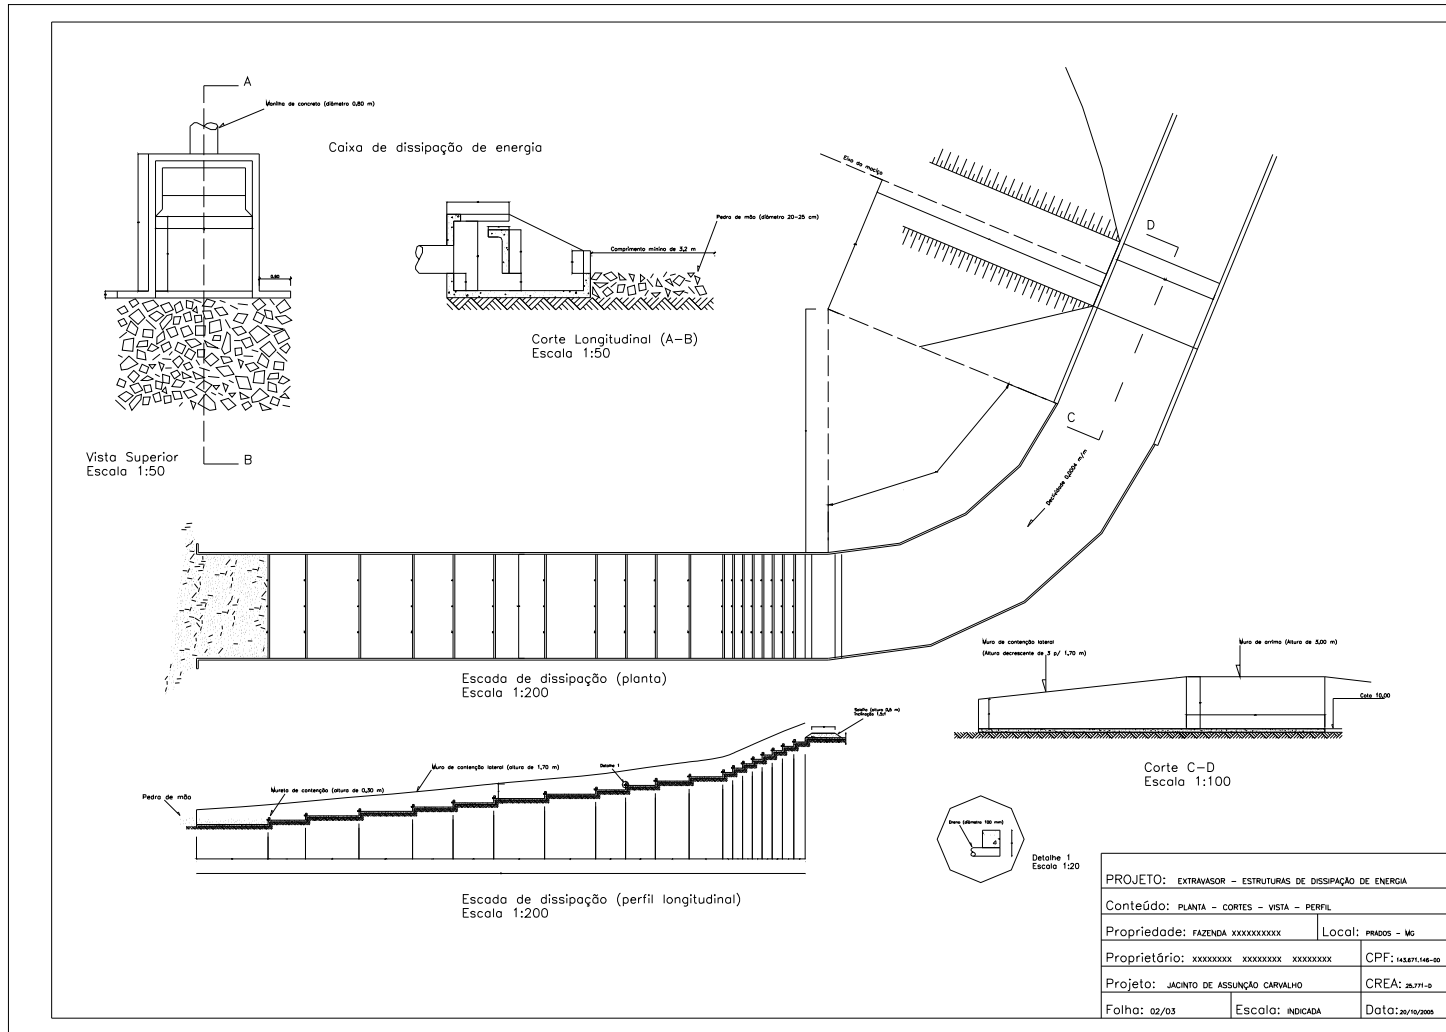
Planta e cortes (dissipadores de energia)
